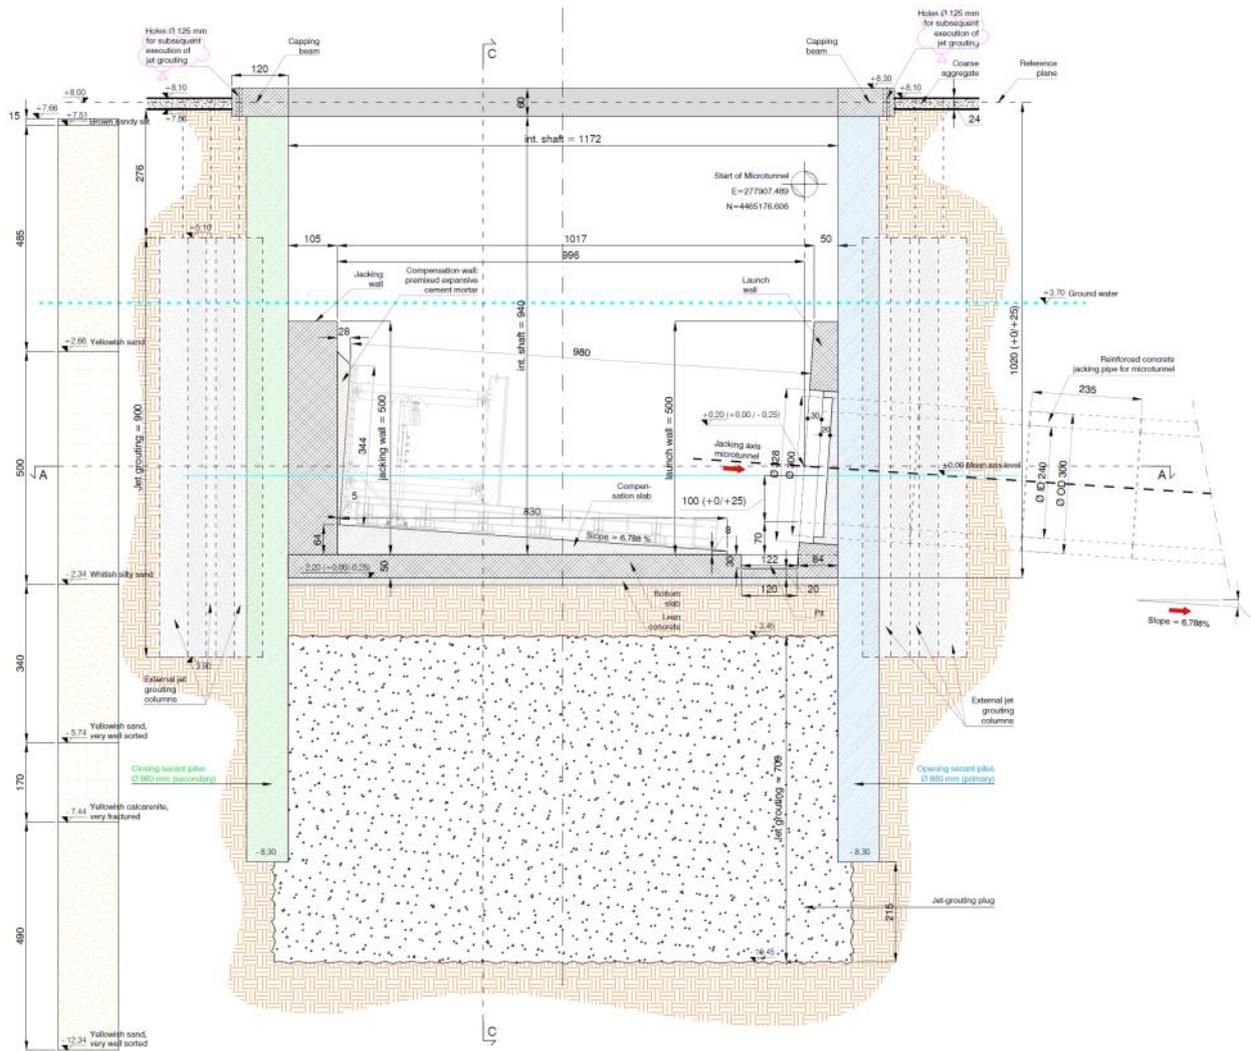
Pozzo di spinta: sezione in pianta e sezione verticale lungo l'asse microtunnel
